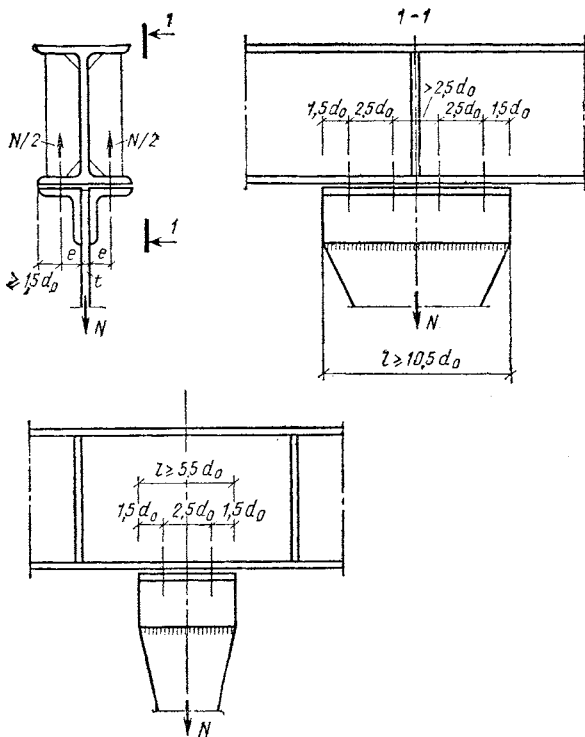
К расчету болтового крепления подвески на растяжение
